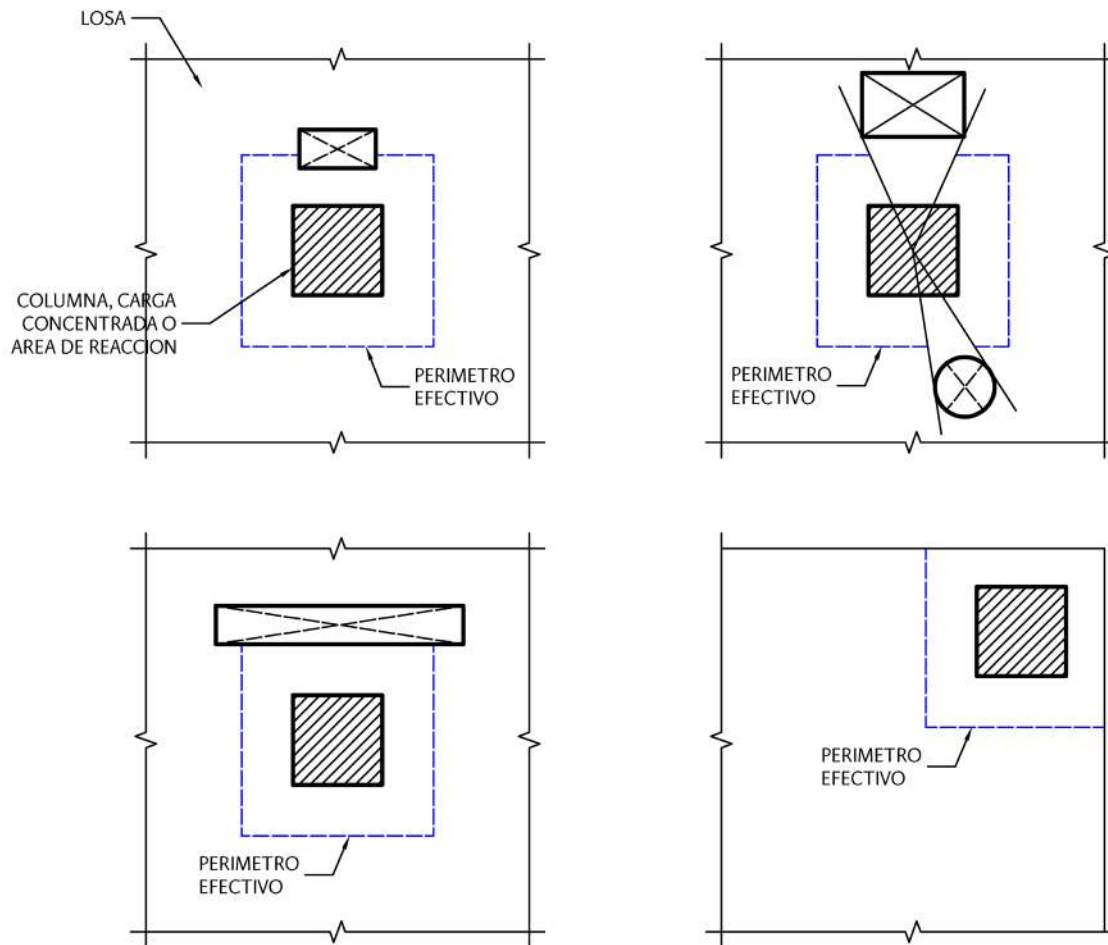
Perímetro efectivo para cortante. Referencia: 5.6.10.14.
